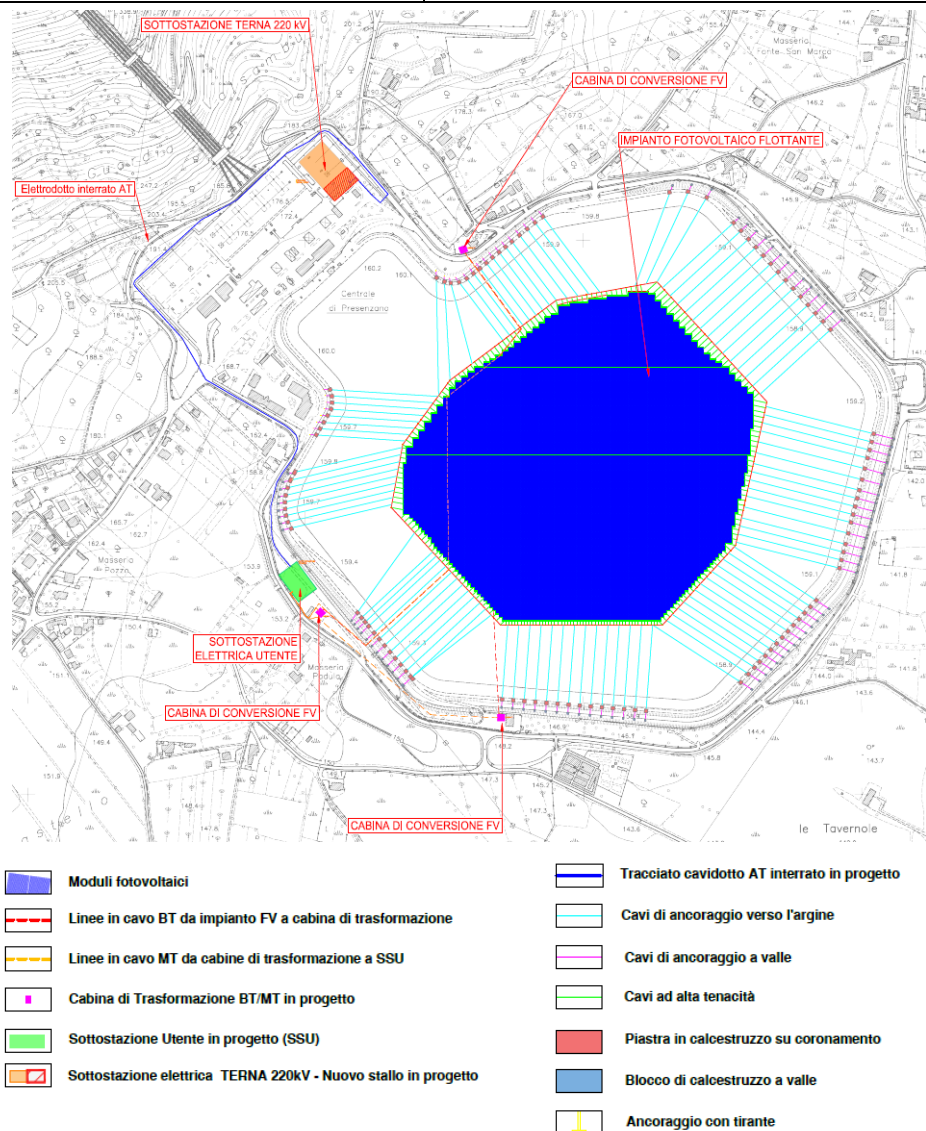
Layout su CTR per Progetto Definitivo di impianto e connessione alla RTN
